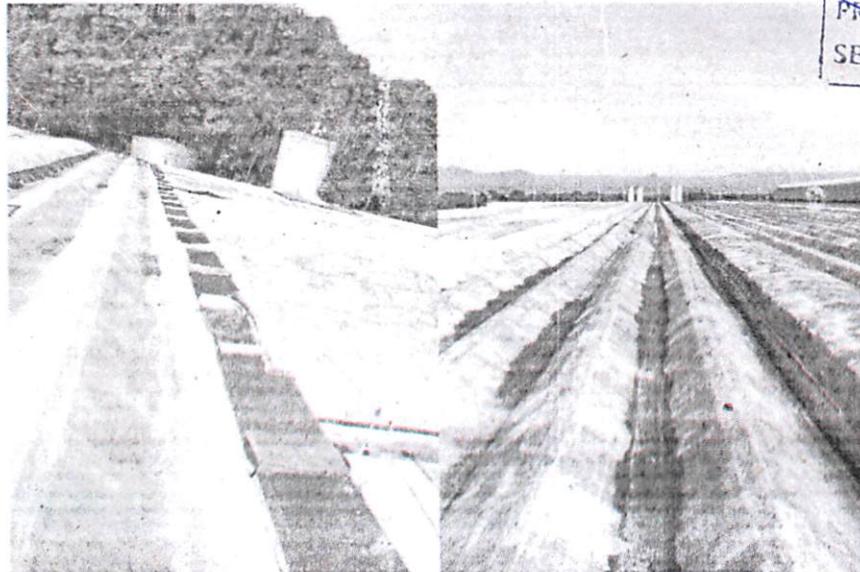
Vista geral do telhado do super mercado – telha tipo canaletão, com a vigas calhas para a coleta e condução das águas pluviais.
